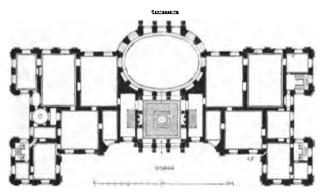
Schloss Vaux-le-Vicomte. Grundriss des Erdgeschoffes.
